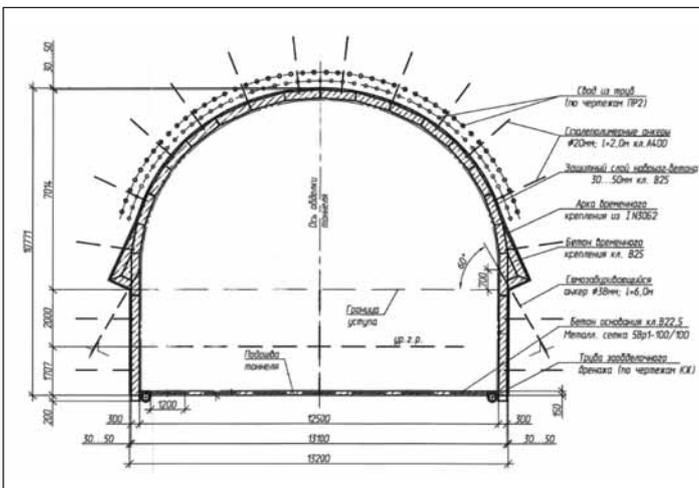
Временное крепление при механизированном способе разработки грунта в условиях неустойчивого грунтового массива
